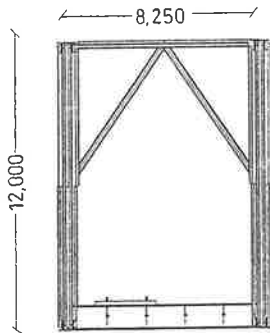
Brückenportal mit einseitigem Gleis. – Bridge frame with railway track on one side
